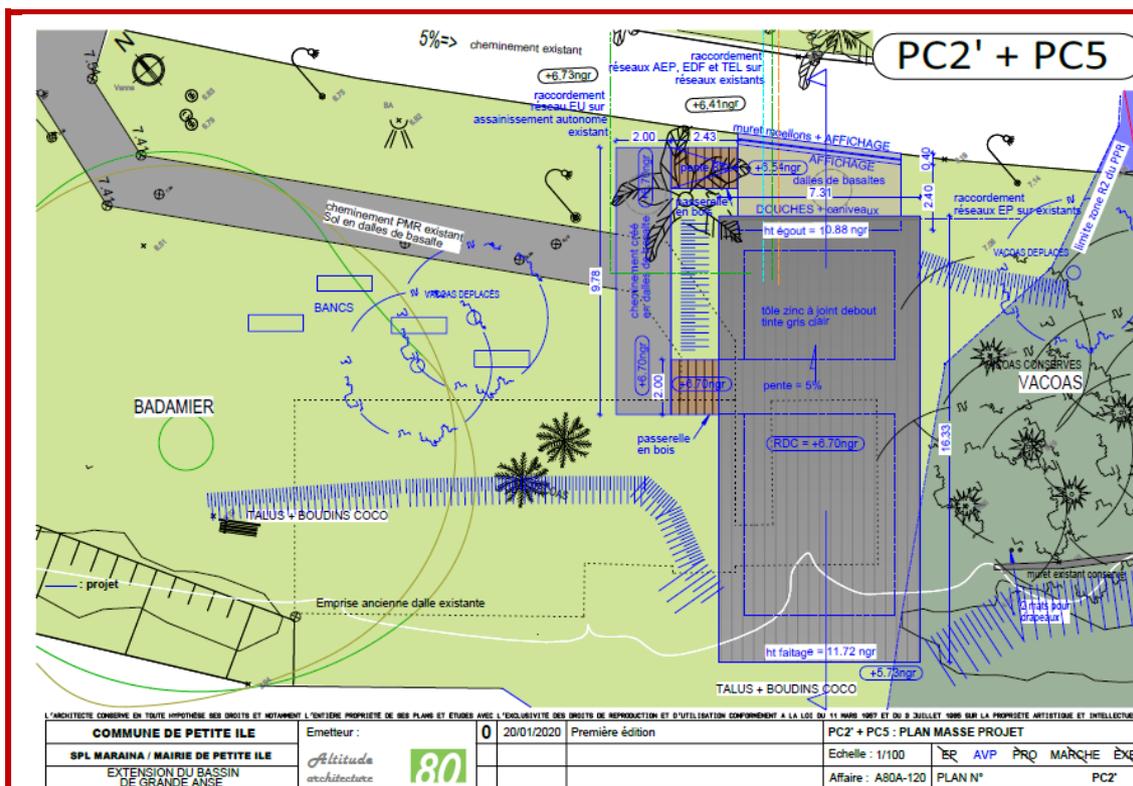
Plan masse du poste MNS figurant à la demande de permis de construire
